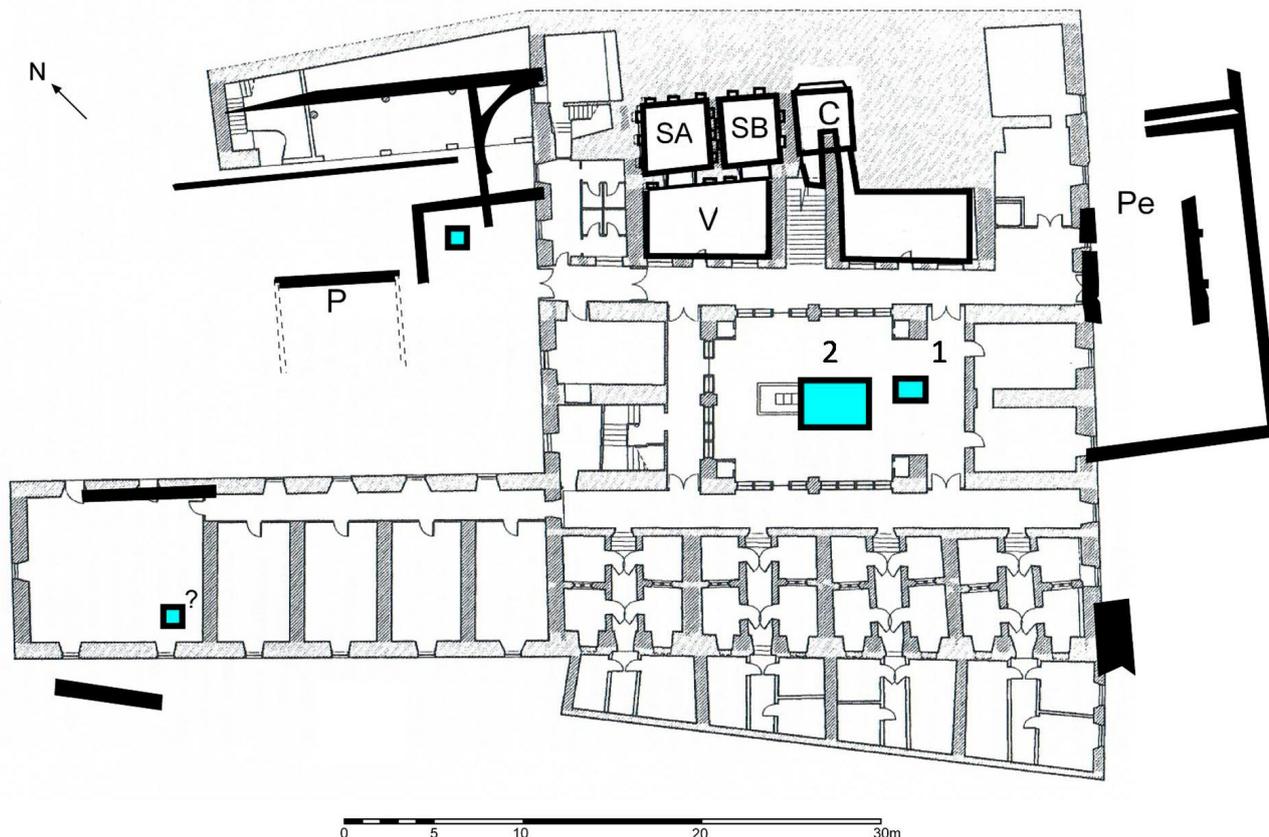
Planta esquemática del establecimiento de baños actual, con las estructuras romanas conservadas (en oscuro) y la localización de las estructuras citadas en este artículo: 1 = Pozo receptor; 2 = Pozo-estaque. A partir del plano de Arias Vilas (1997, 349) y Meijide y Hervés (2000).
